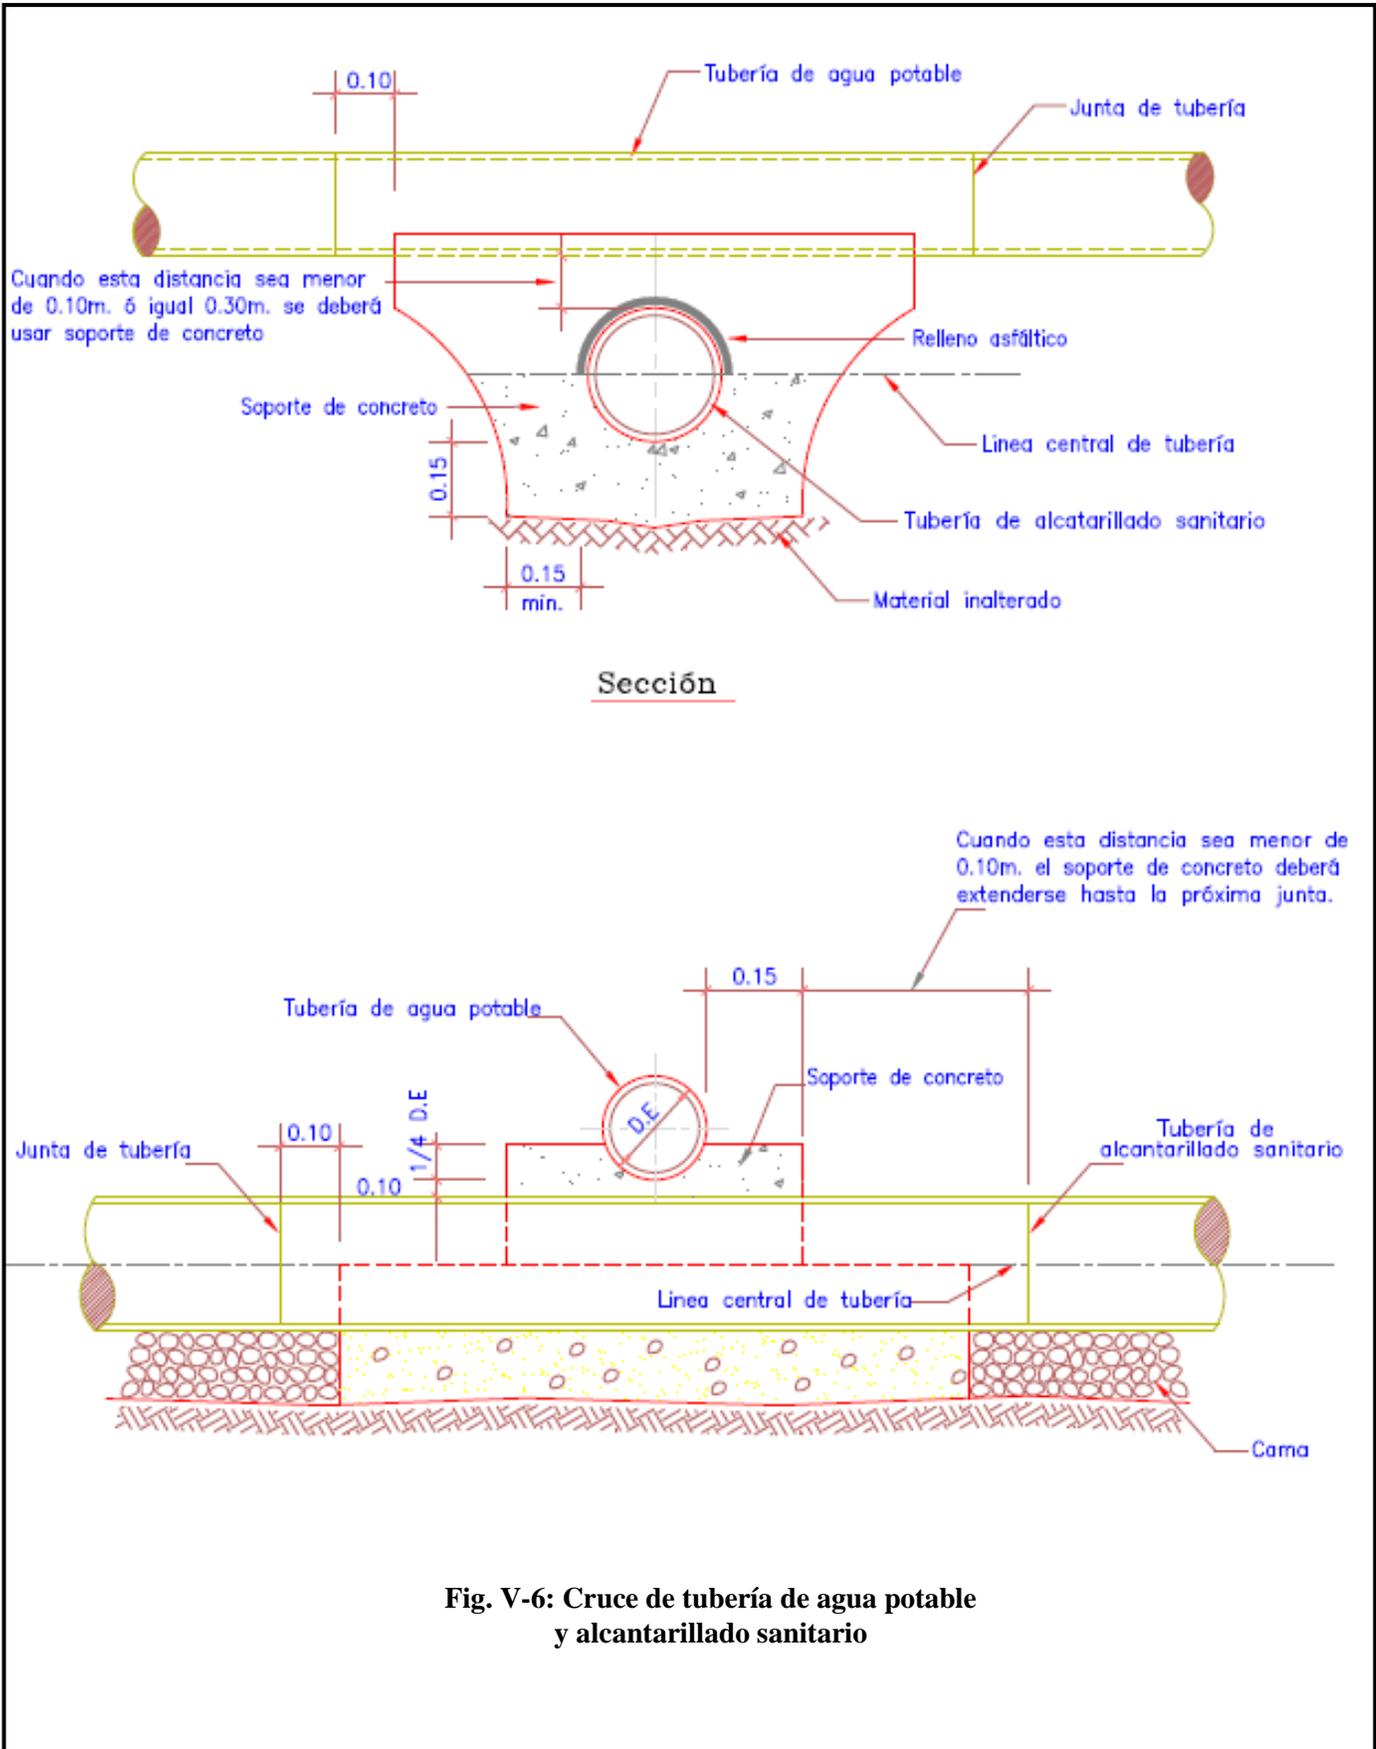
Cruce de tubería de agua potable y alcantarillado sanitario
